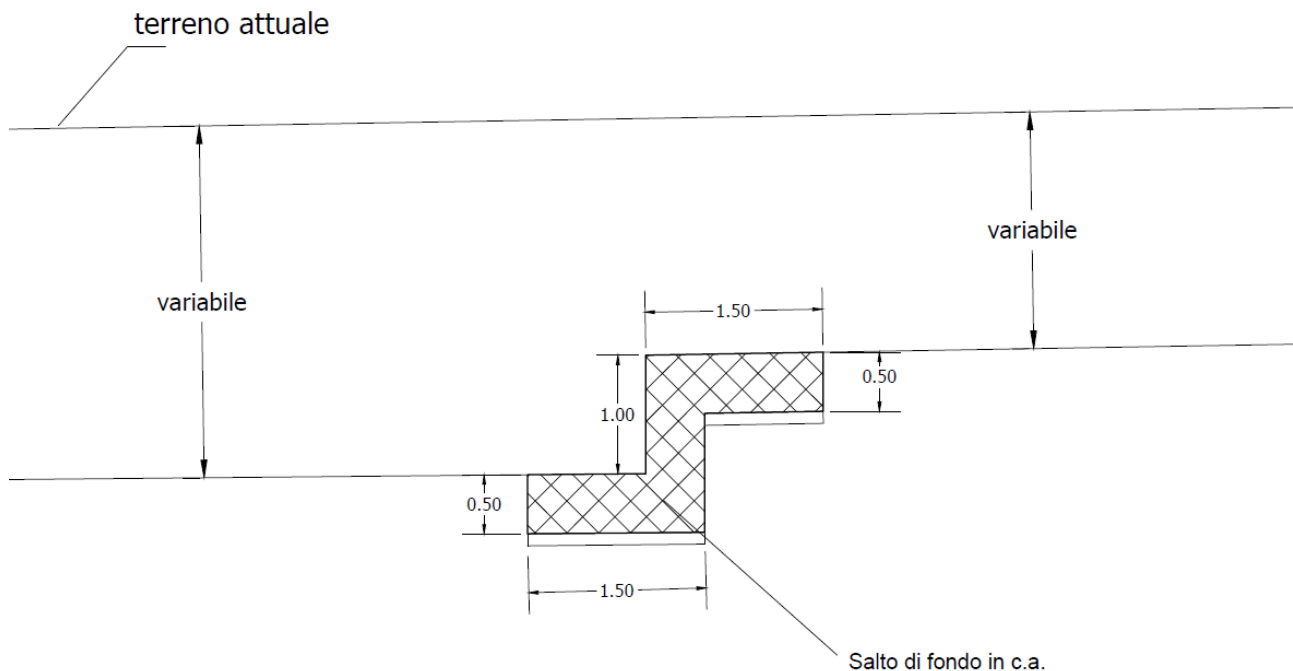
Sezione tipo - Salto di fondo a monte del 1 attraversamento
